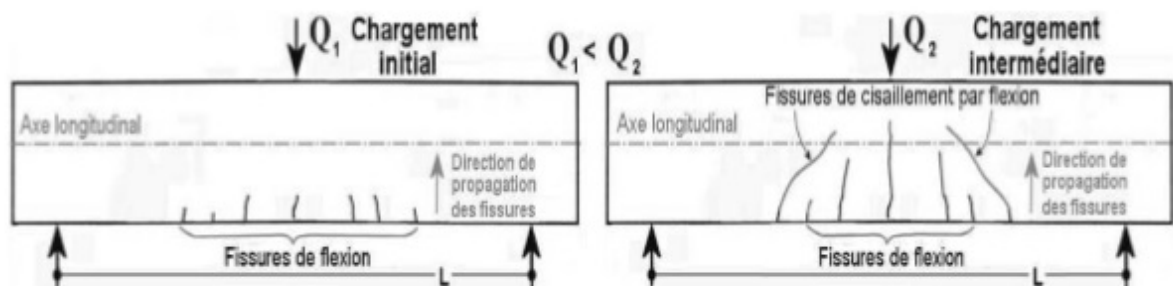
Représentation de la fissuration initiale et intermédiaire par flexion d'une poutre en béton armé (BA). [Chedad 2016]
